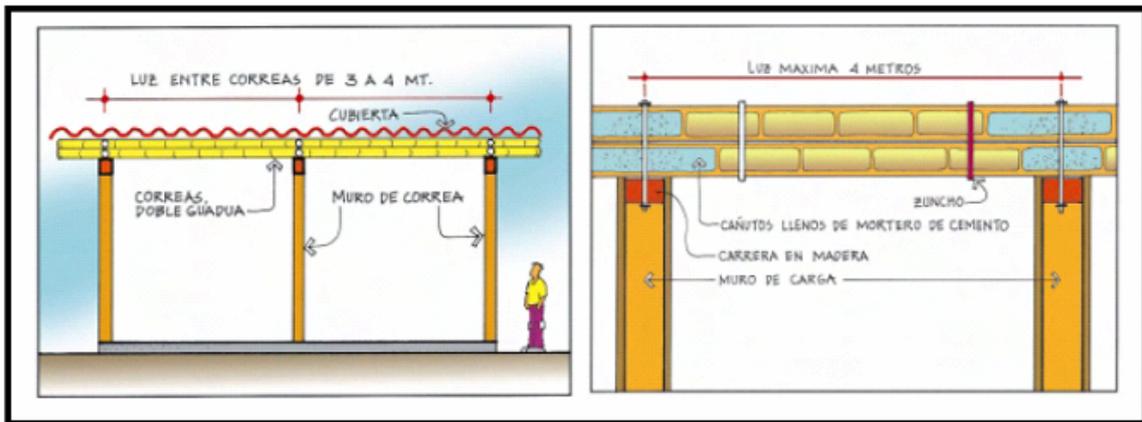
Detalle cubierta. Fuente AIS
